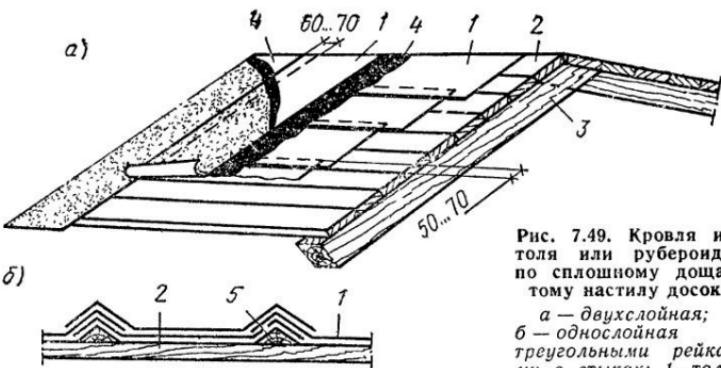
Кровля из толя или рубероида по сплошному дощатому настилу досок
